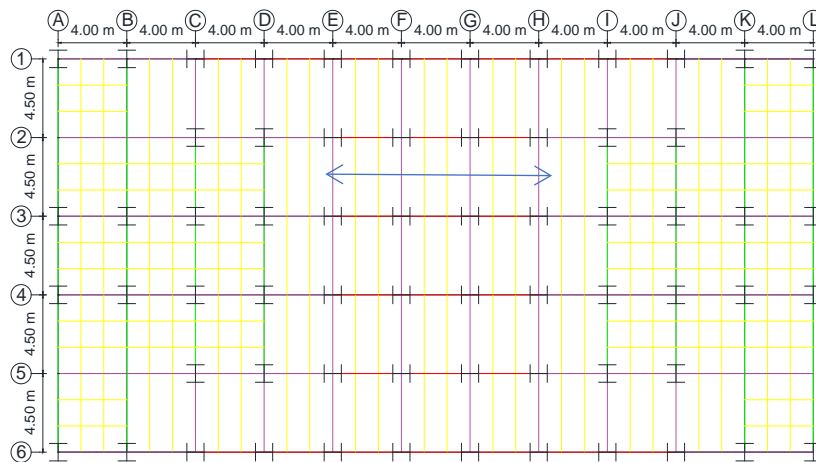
Planta de techo de la edificación híbrida con panel Vierendeel 1m.
